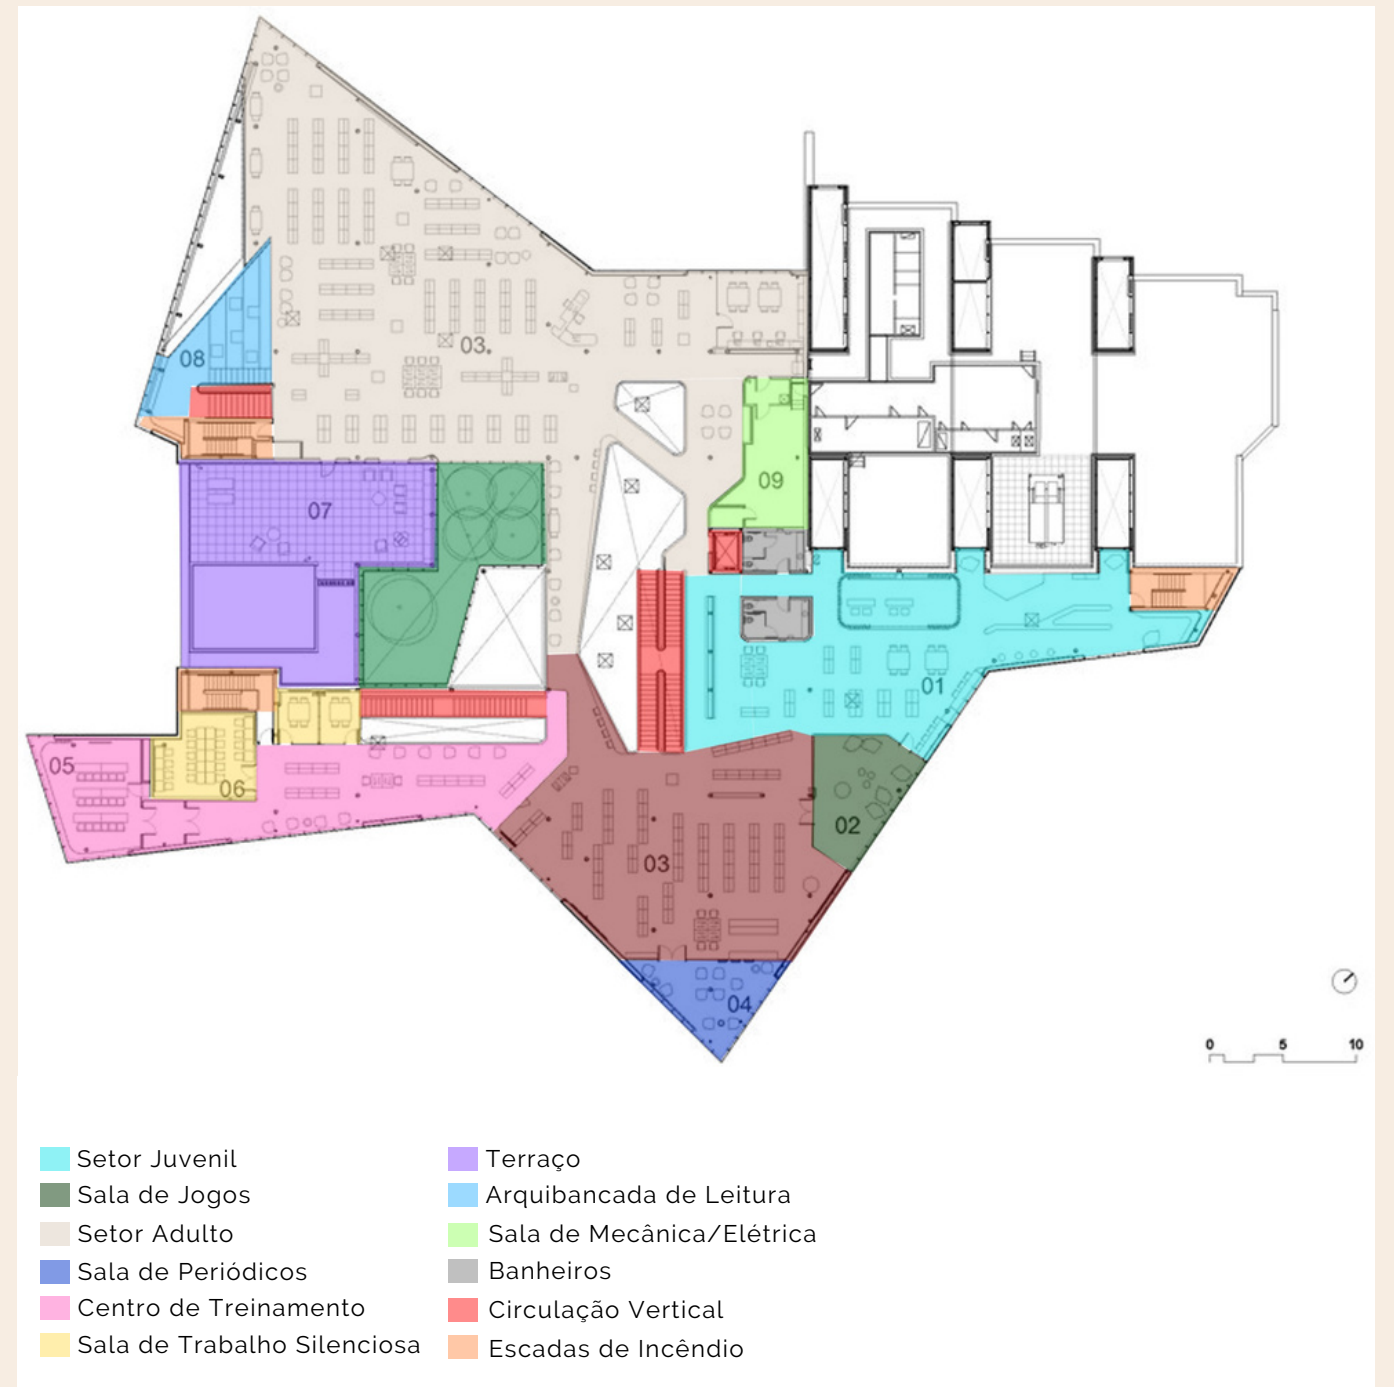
Setorização do Primeiro Pavimento Biblioteca Pública Pierrefonds
